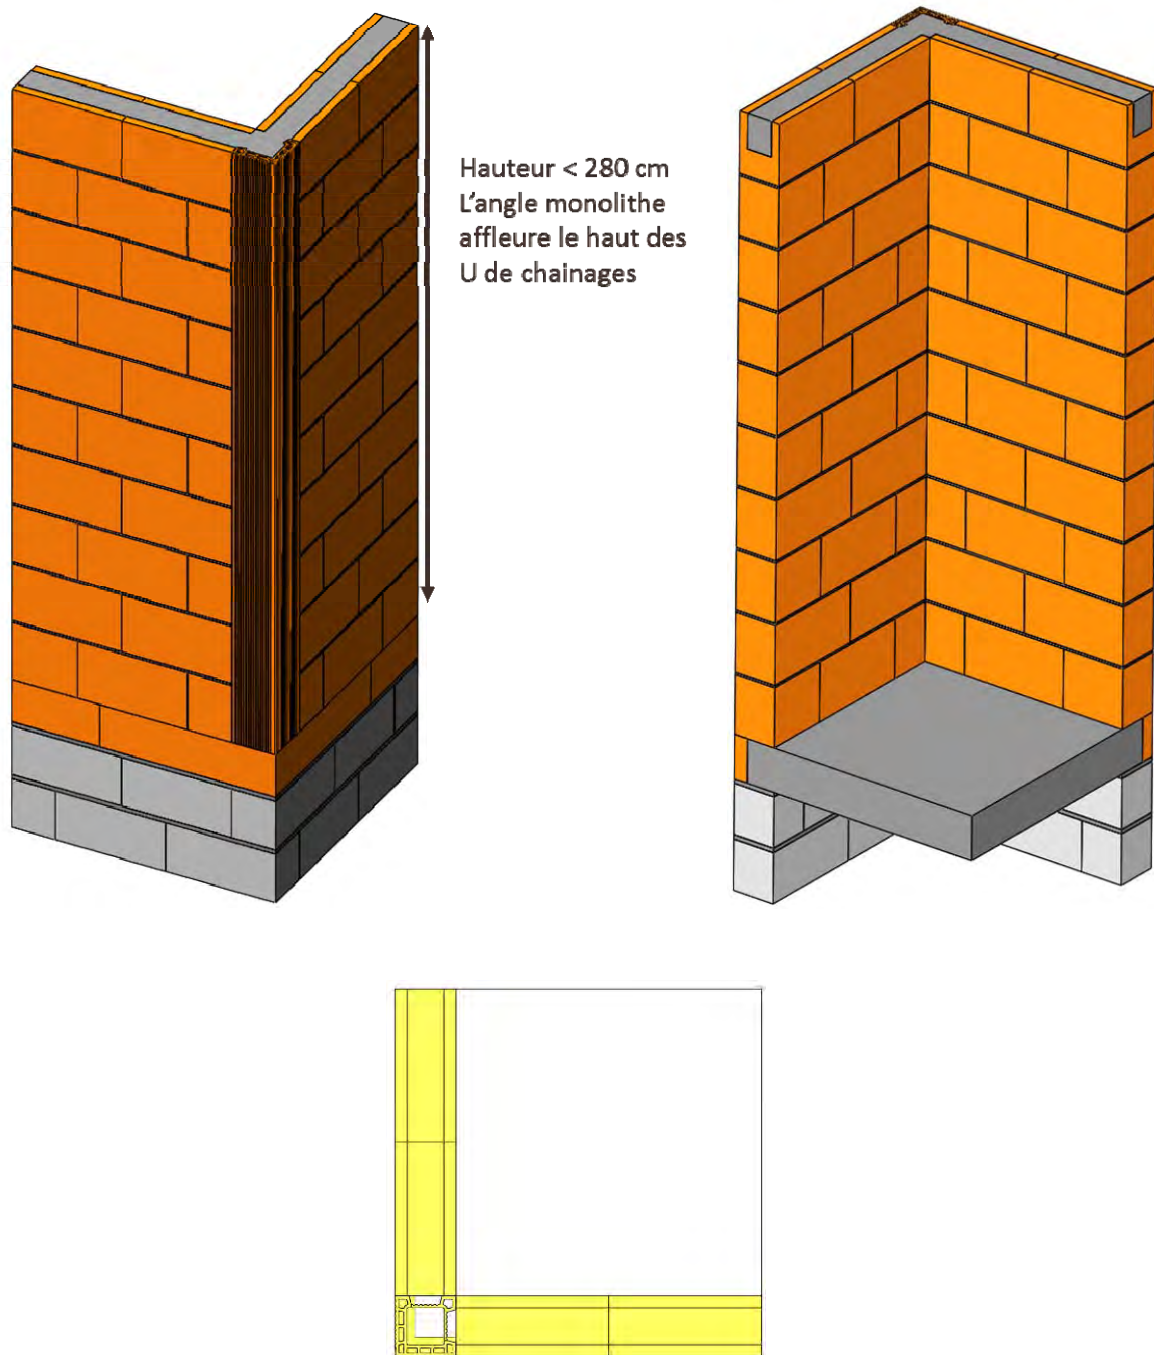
détail pour des bâtiments dont la hauteur entre le plancher et le haut des U de chainages est inférieur à 280 cm.
